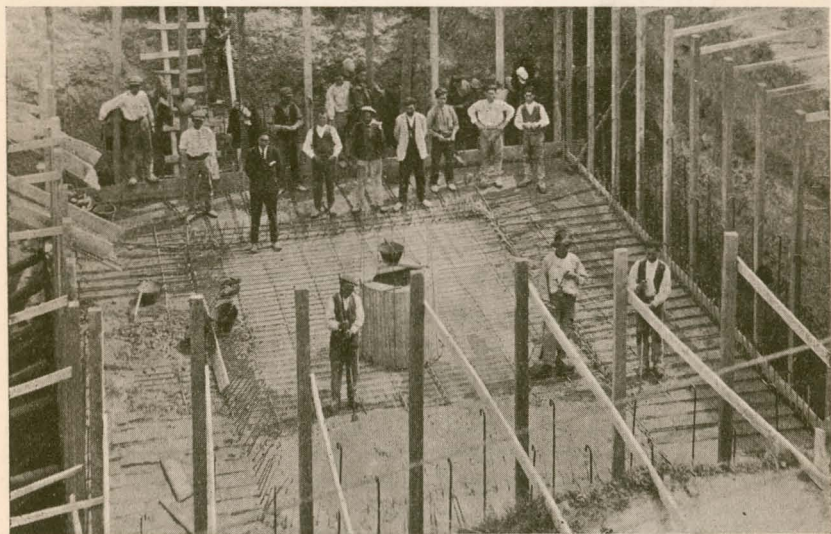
Cajón de un estribo del puente de Montesa menor.
